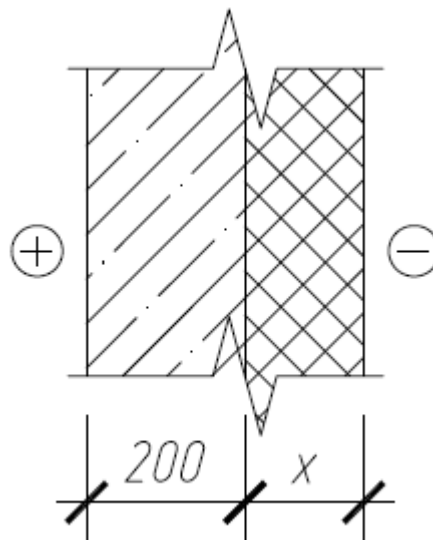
Конструкция наружной стены лестничной клетки
